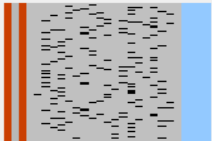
Cerramiento horizontal "Cerramiento entre plantas"
